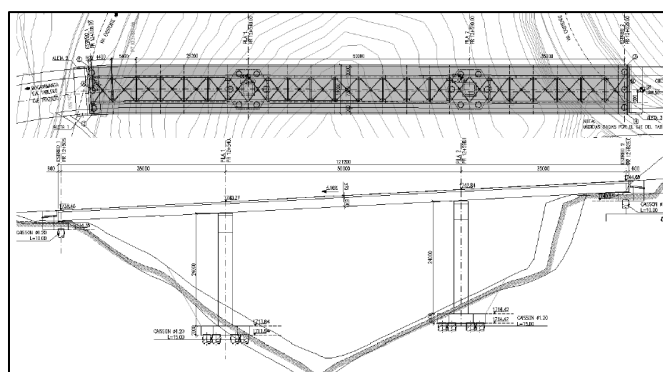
Planta y alzado de puente PR12+505 (Suarez, 2017).
